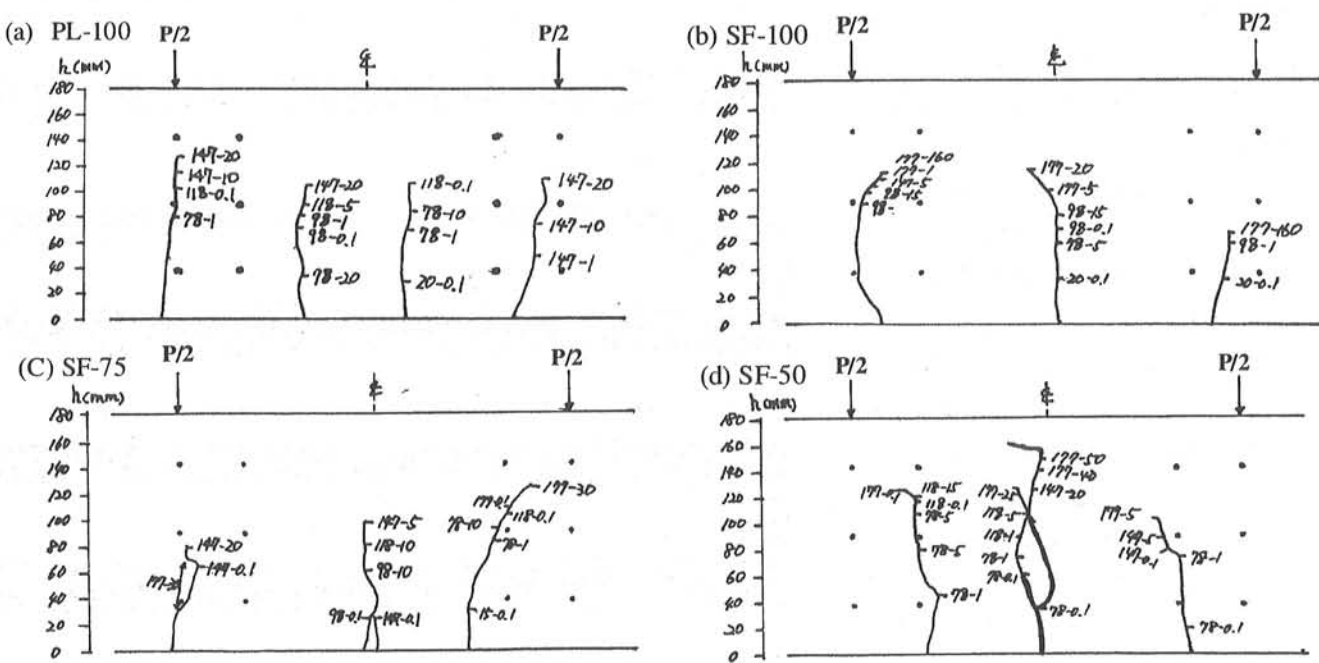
ひび割れ状況(曲げスパン内)
